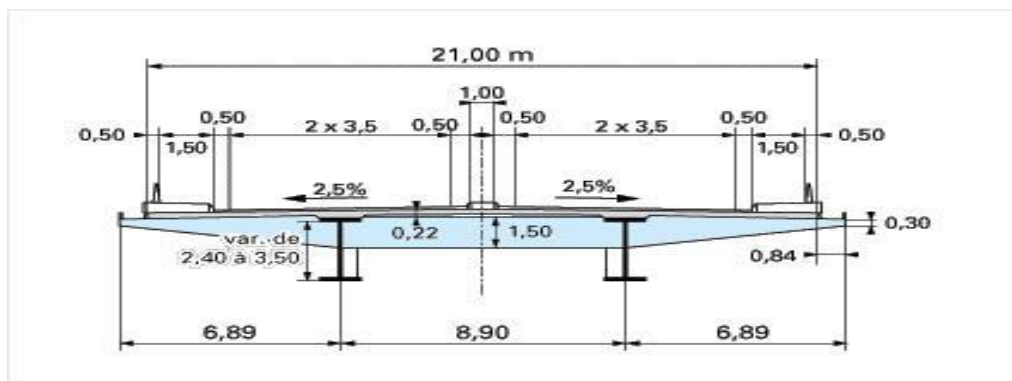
Tablier bipoutre large avec pièces de pont et consoles [2]
